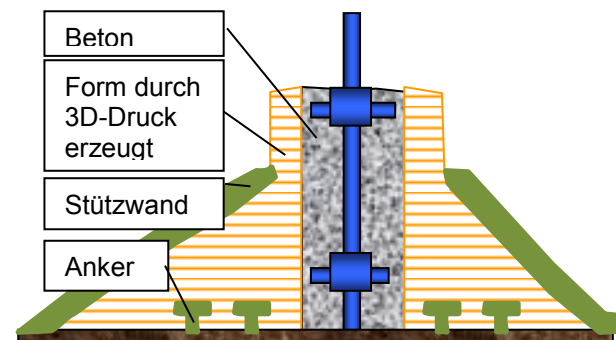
Schalungsaufbau mit 3D-Druck und herkömmliches Betongussverfahren mit Bewehrung
